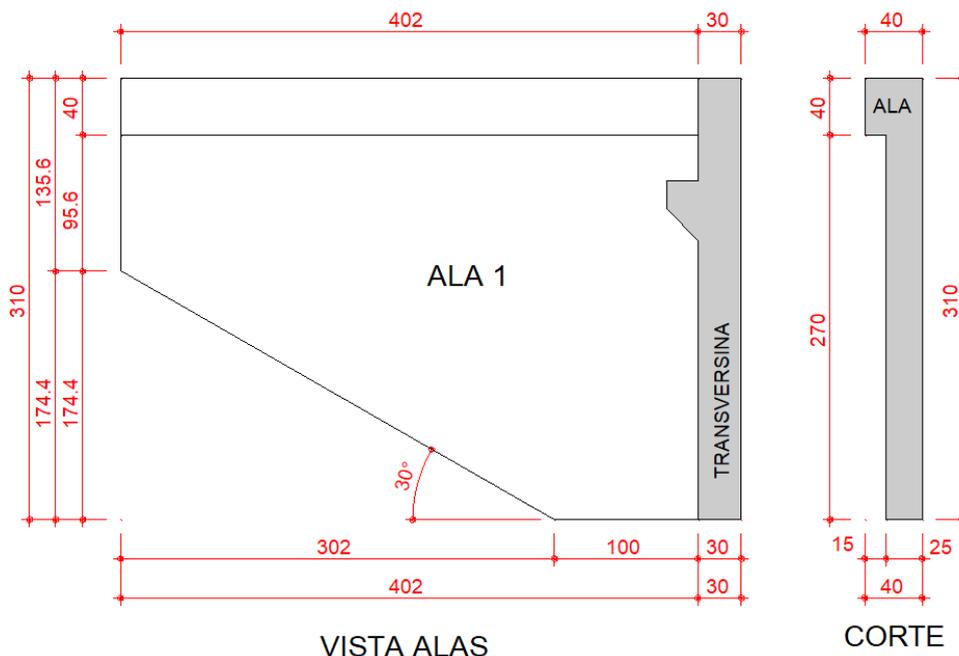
Detalhe das transversinas de apoio – Proposta 2
